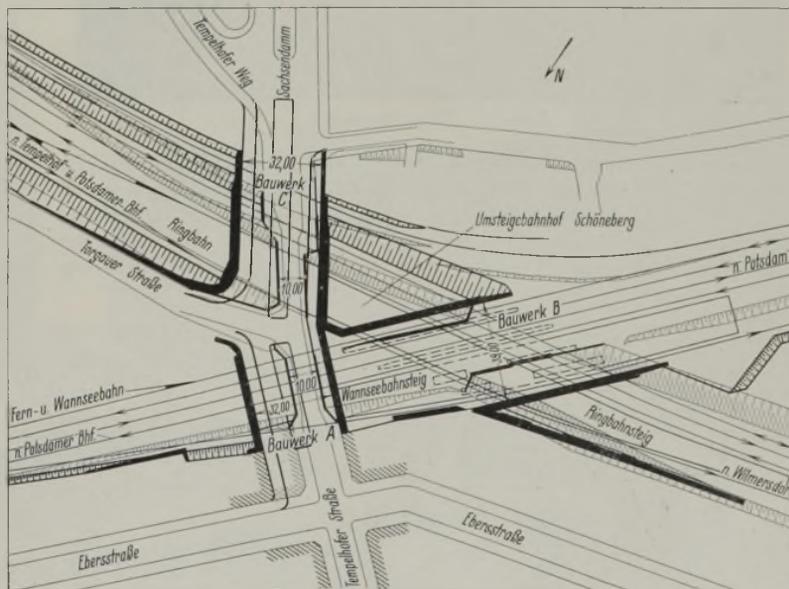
Unterführung Tempelhofer Straße. Lageplan.
